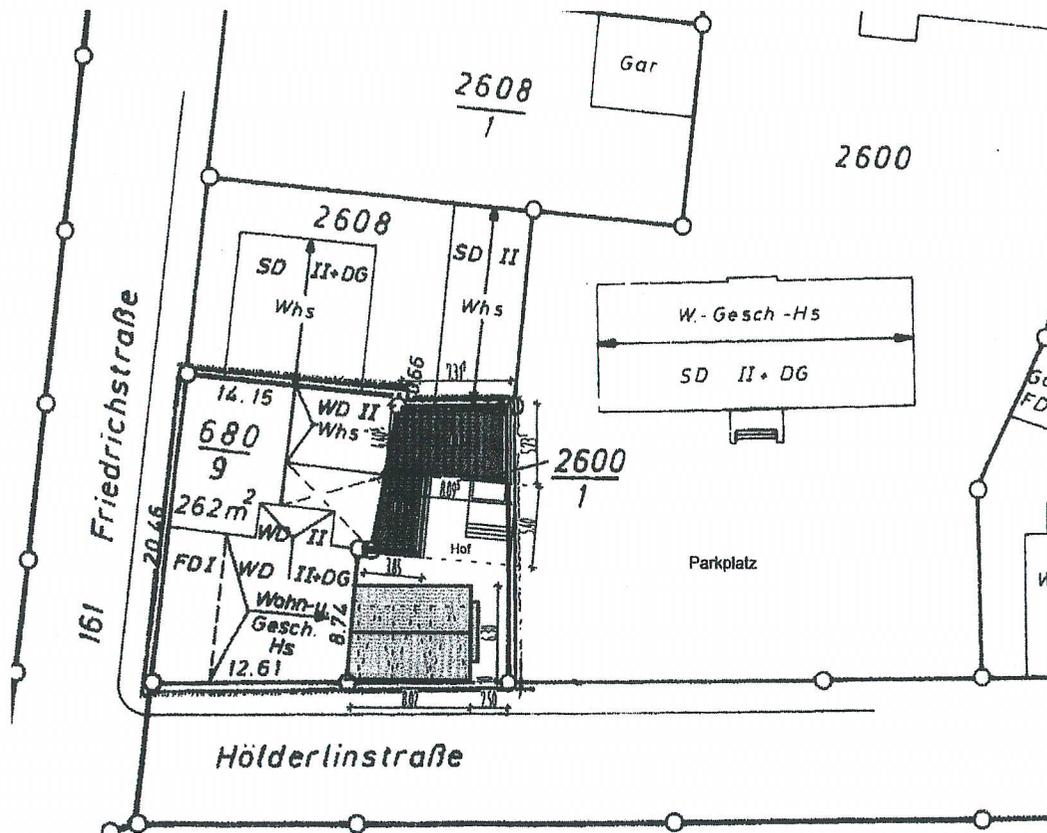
Lageplan Bauvoranfrage Flst.-Nr. 680/9 und 2600/1 (ca. M 1:500, Norden rechts)
